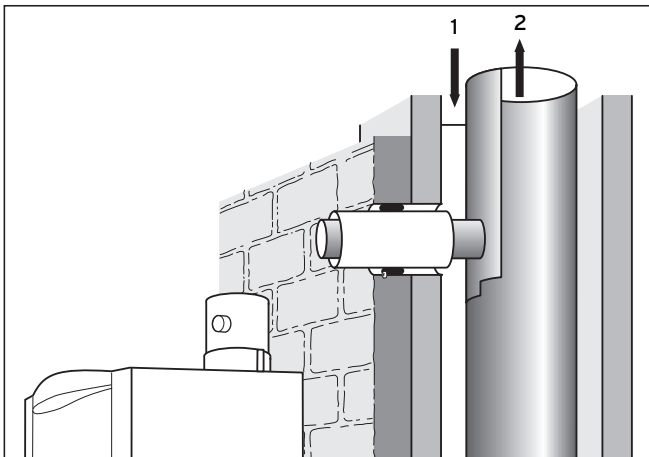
Raccourcir la longueur du conduit des fumées et installer le conduit d'air
